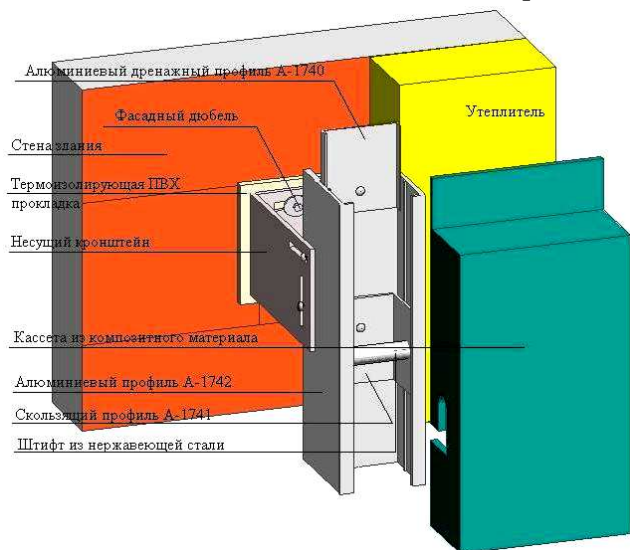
Схема навесного вентилируемого фасада с использованием кассет из композитного материала
